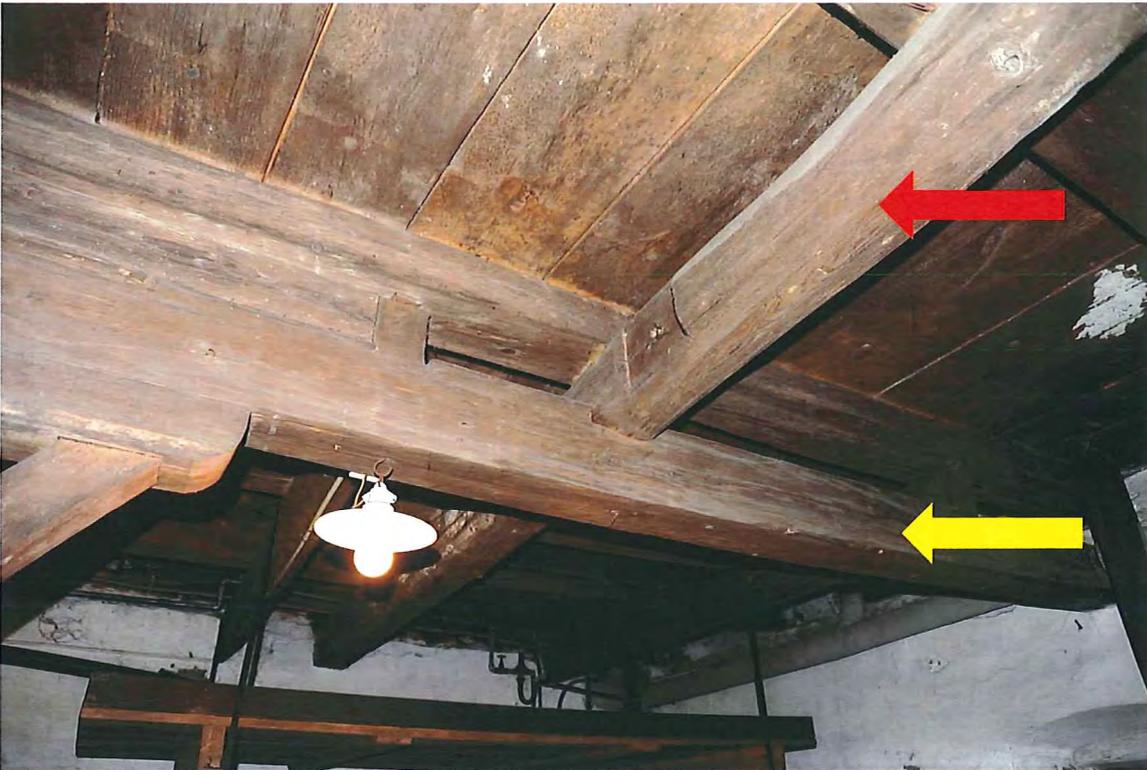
Kellergeschoss, Raum -1.03. Unterzüge unter Deckenbalkenlage (Pfeil rot: ursprünglich, Pfeil gelb: nachträglich).
